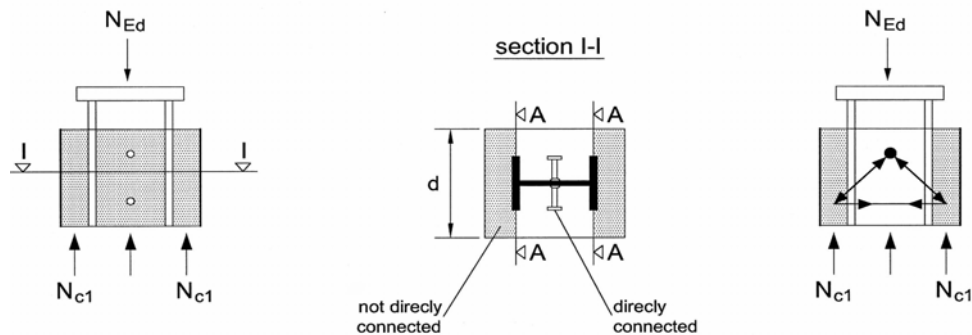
Áreas de concreto direta e não diretamente ligadas para o cálculo da armadura transversal.
